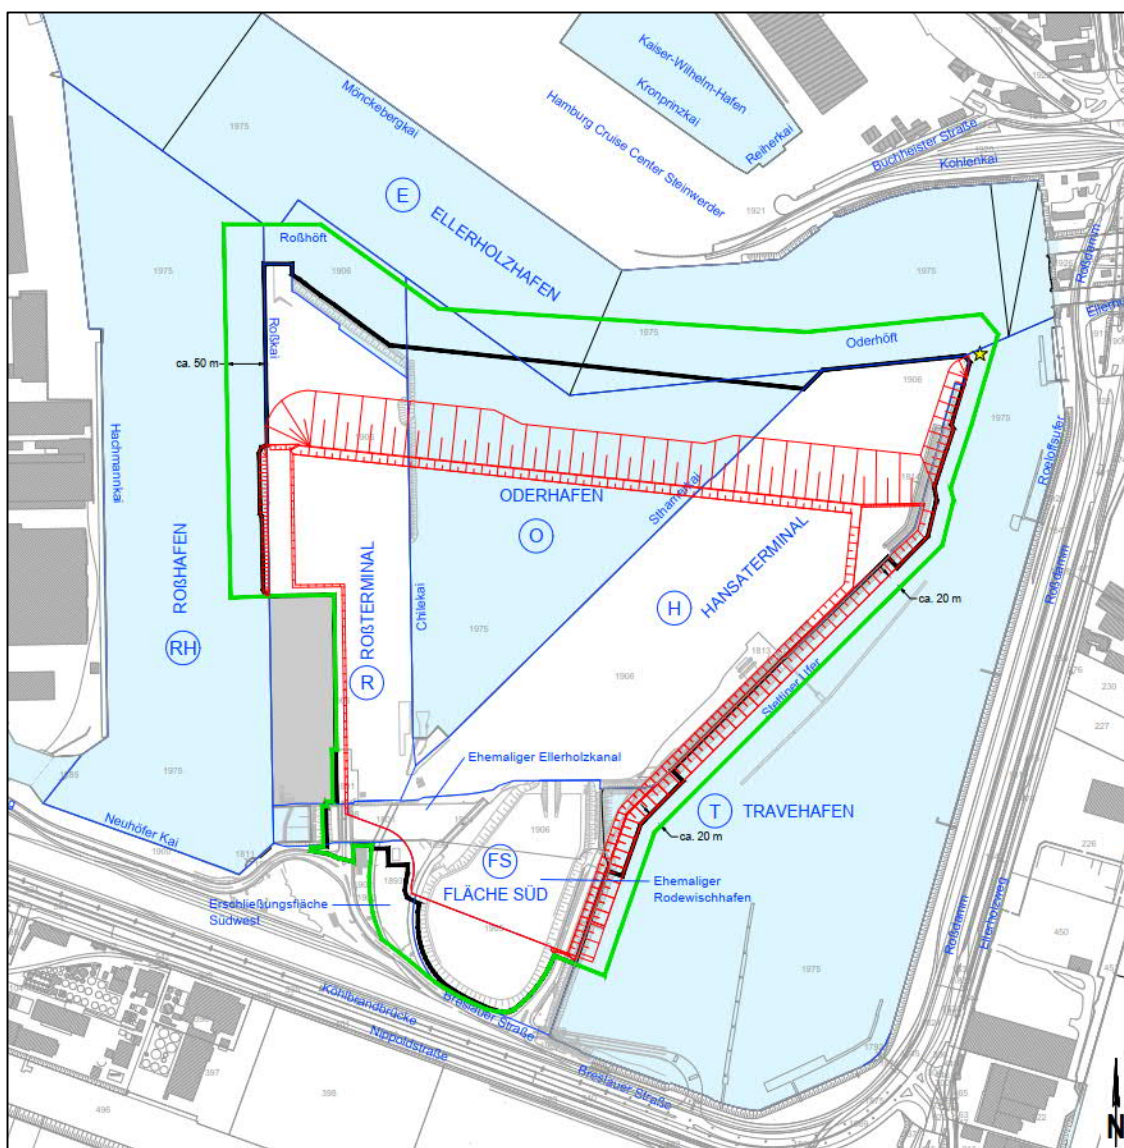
Vorhabensfläche (grün umrandet) mit Teilgebieten, Rück- und Einbaufläche (schwarz umrandet) und geplante Nutzfläche mit Böschungen (rot) (Teil I des Antrages auf Planfeststellung)
